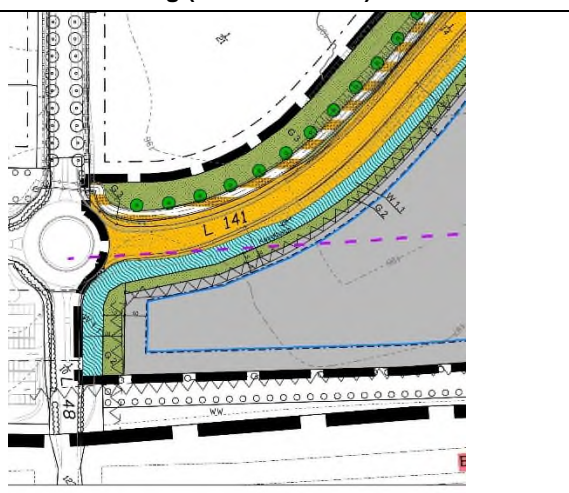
M 9 - Ausschnitt B-Plan der 10. Änderung (unmaßstäblich)
